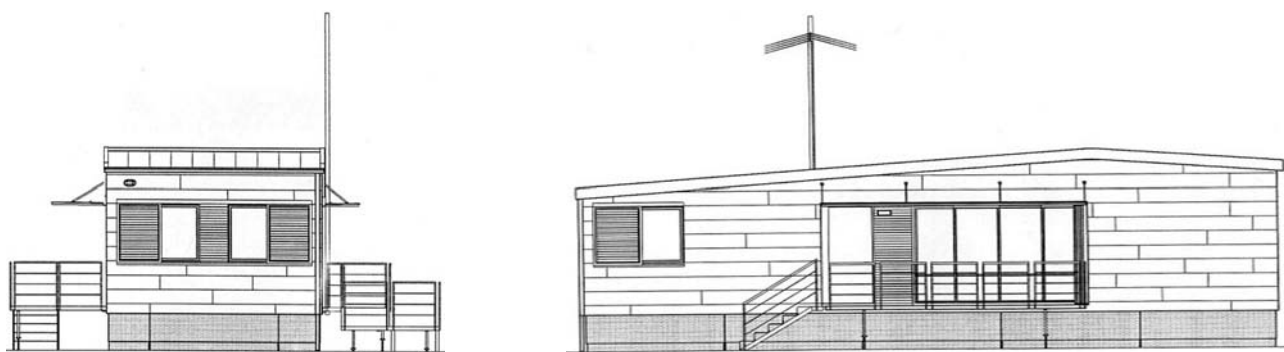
Alzados este (izquierda) y alzado sur (derecha).
